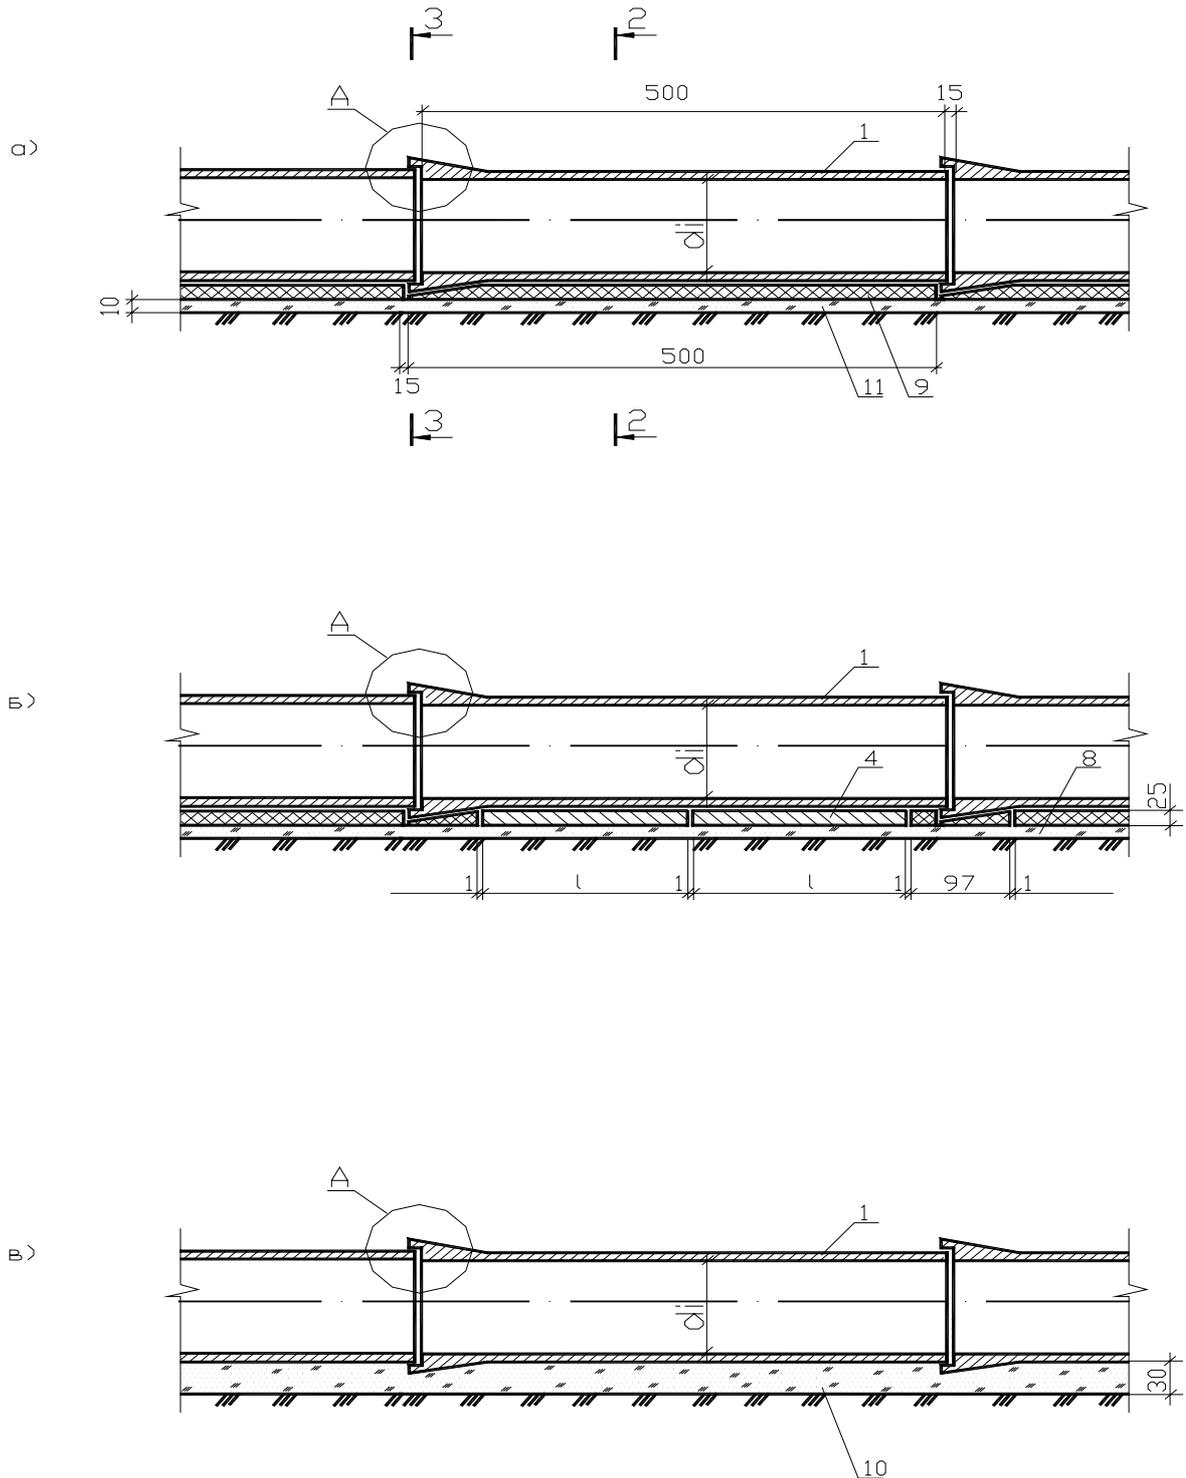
Продольный разрез тела трубы: а) на монолитном фундаменте; б) на сборном фундаменте; в) на гравийно-песчаной подушке; 1 – звено трубы; 4 – блок фундамента; 8 – участок монолитный УМЗ; 9 - монолитный бетон В20; 10- гравийно-песчаная смесь; 11 – подготовка из щебня или гравия
